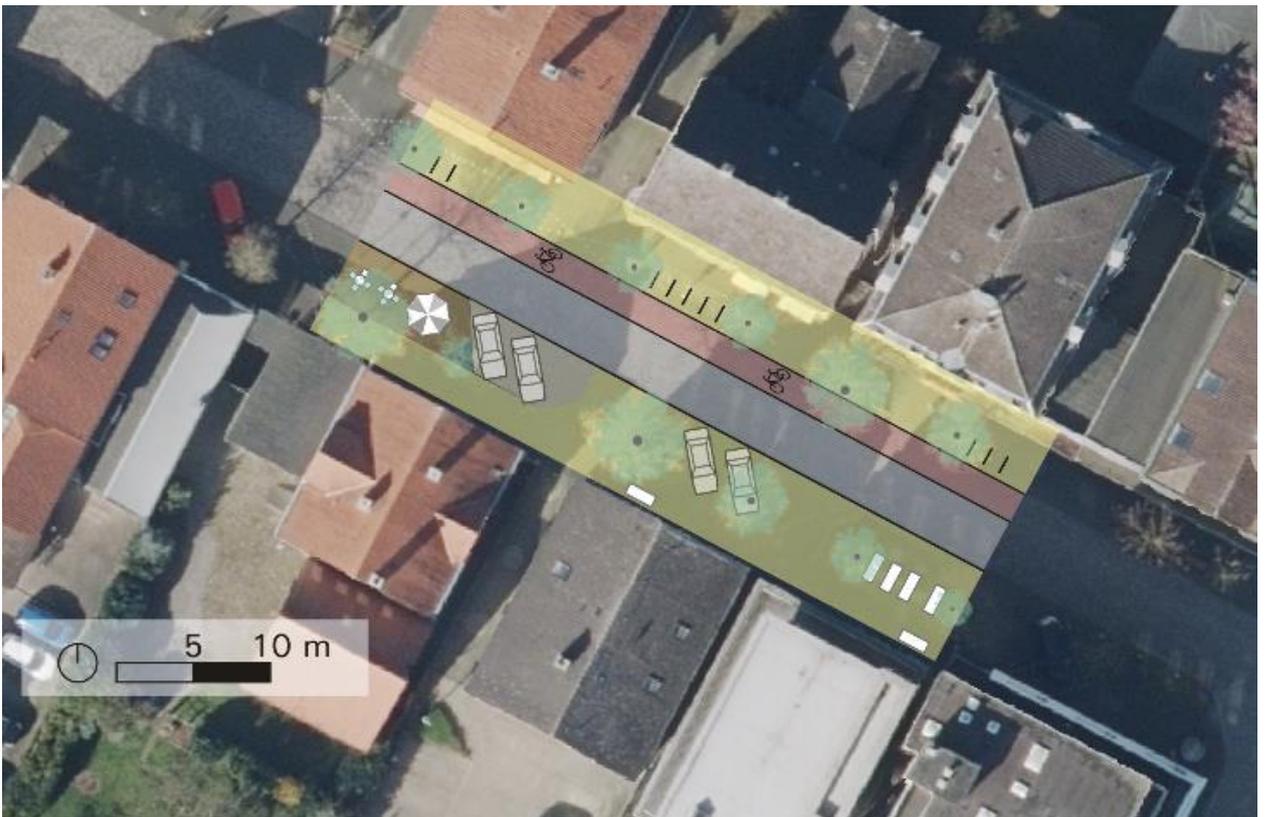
Lageplan Umgestaltungsvorschlag Bahnhofstraße (Variante II)
